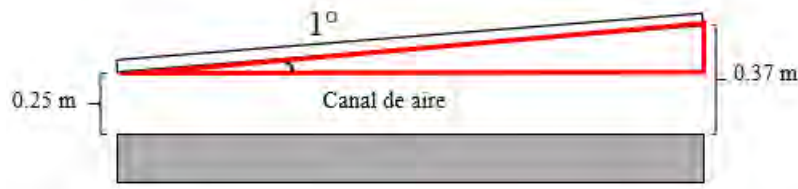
Techo ventilado de las viviendas a 1° de inclinación.
